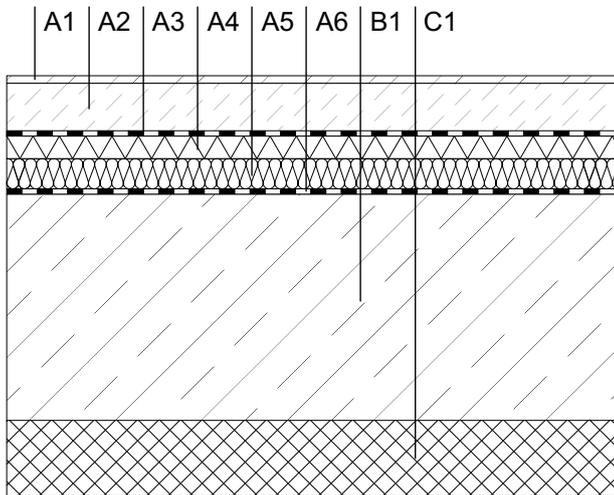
Vertikalschnitt Bodenplattenaufbau BO, M 1:10
